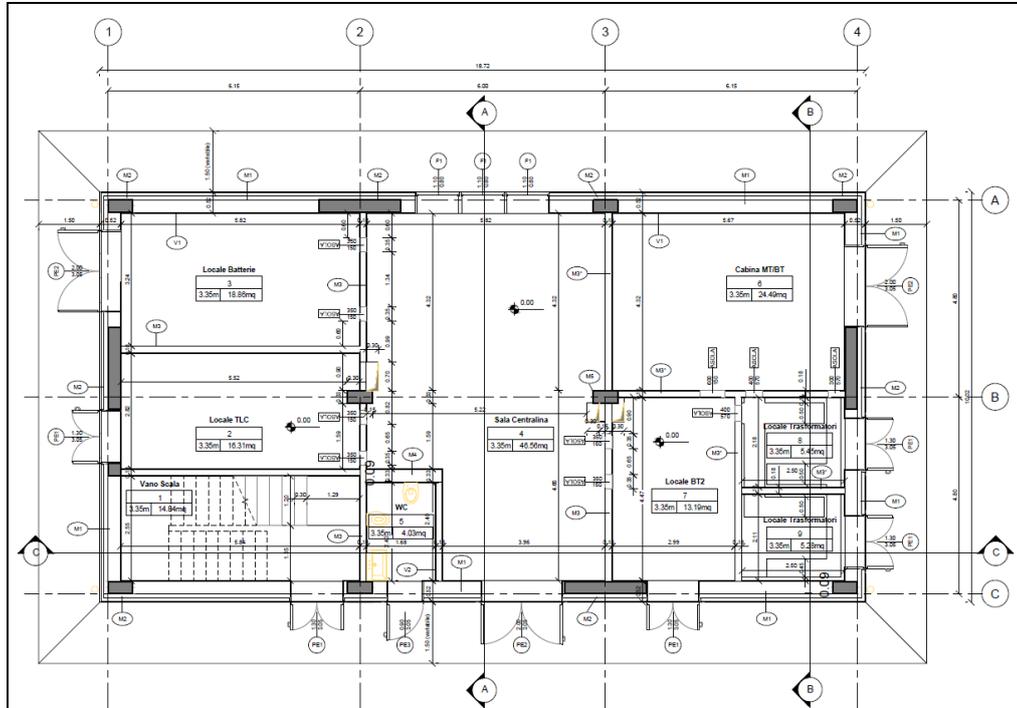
PPM di Pieve Emanuele. Pianta piano Terra.
